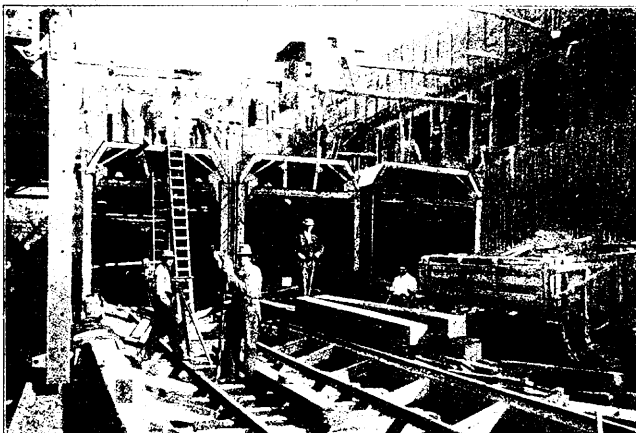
Bau der IV. Avenue-Untergrundbahn in Brooklyn. Anwendung beweglicher, eiserner Schalungen für den Betontunnel.
